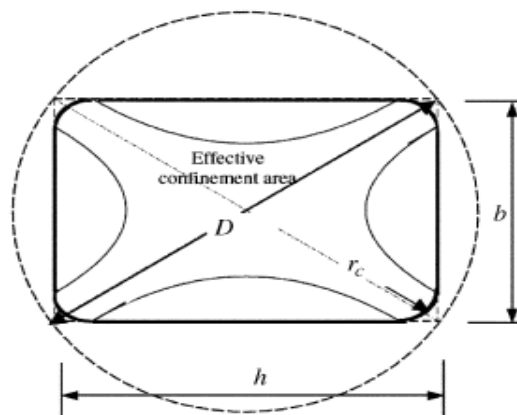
Área de confinamiento efectiva para columnas con sección rectangular.
